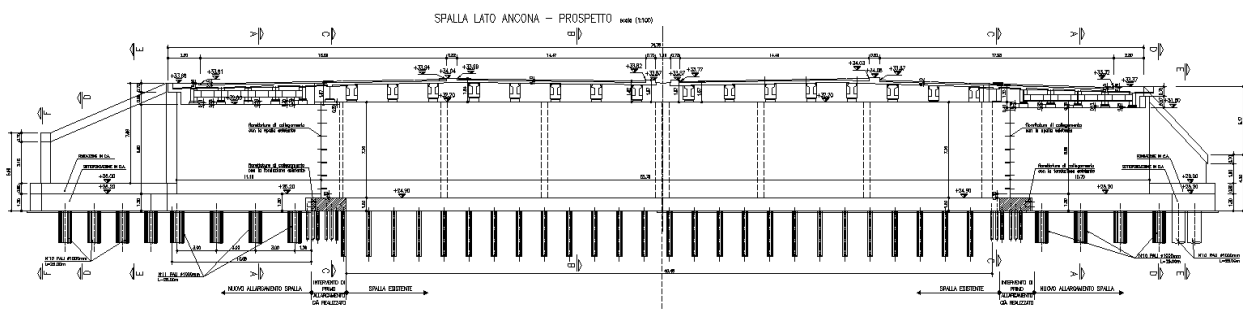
Sezione trasversale Spalla lato Ancona
